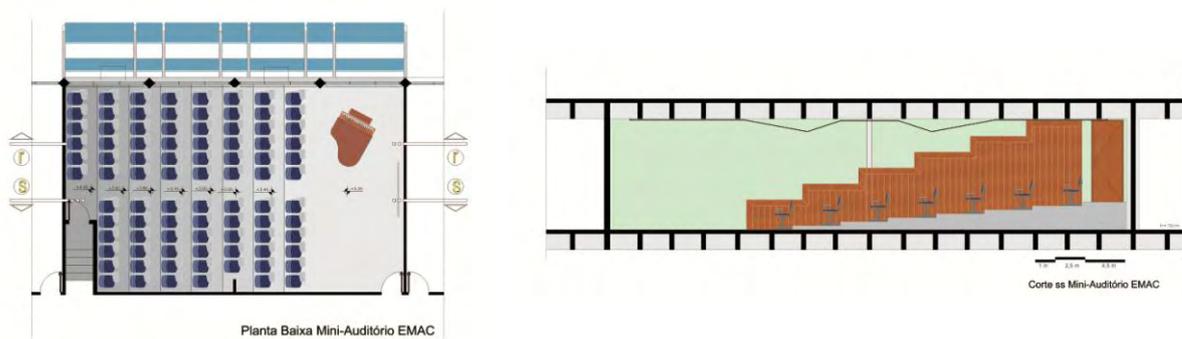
Planta e corte do mini-auditório da Emac. Adaptado arquivo Cegef
